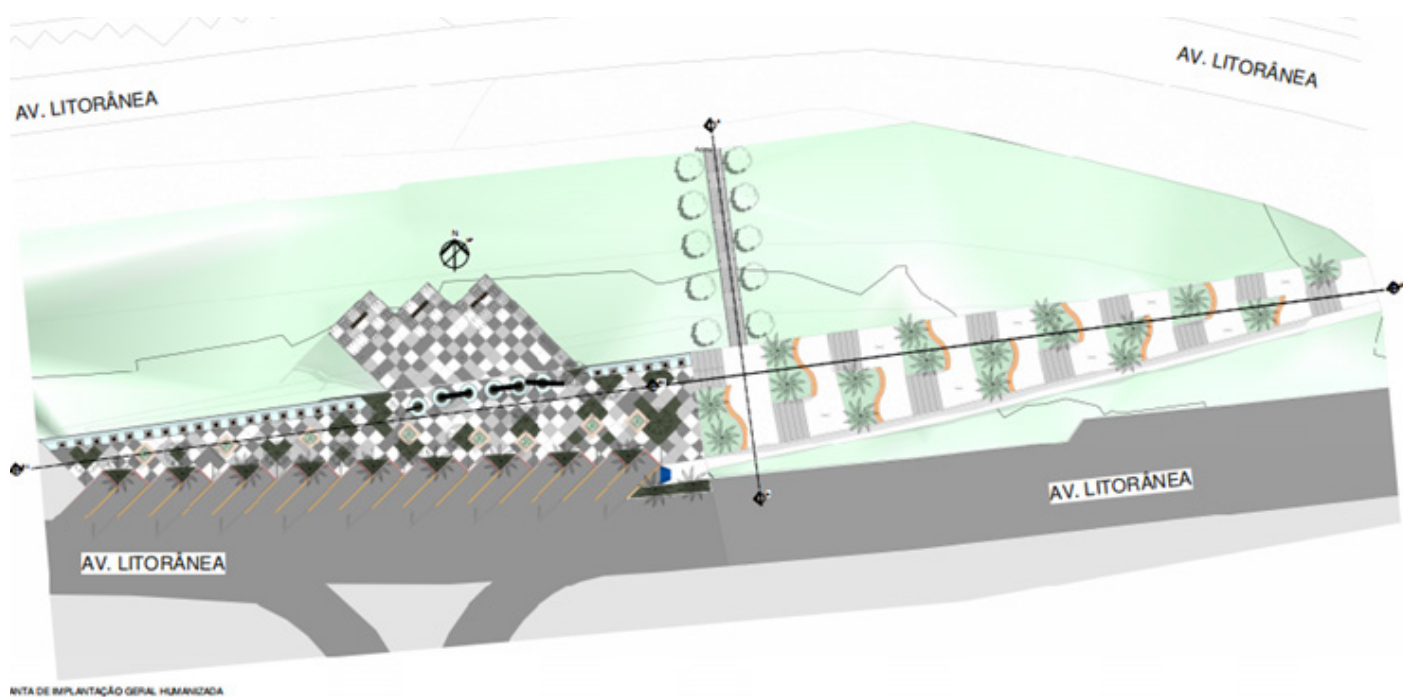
Layout do projeto de Pocket Park na Av. Litorânea
